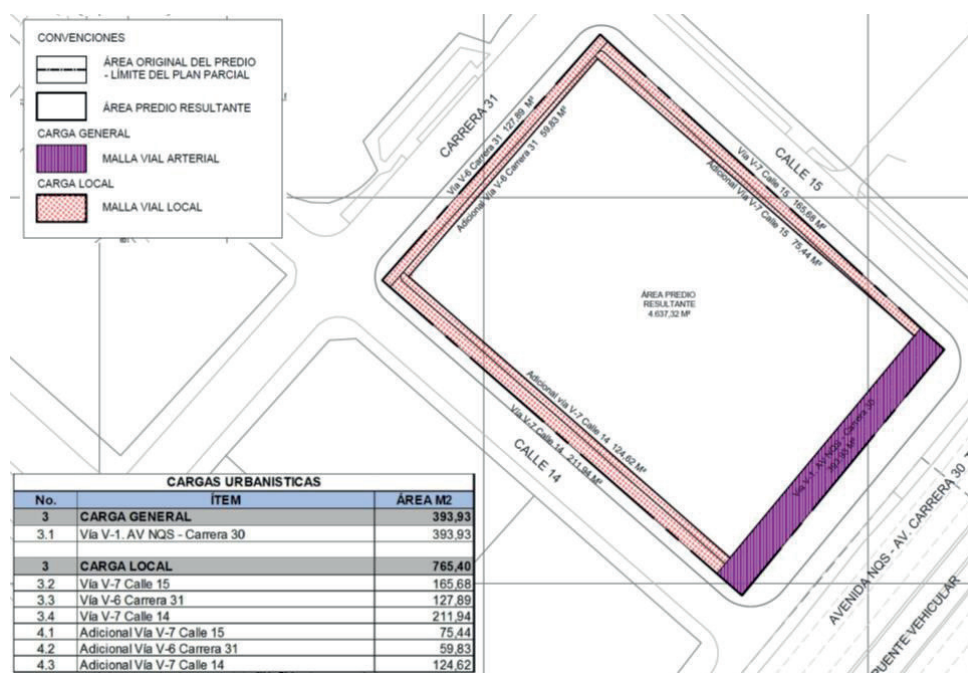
Plano de cargas generales y locales del Plan Parcial.
